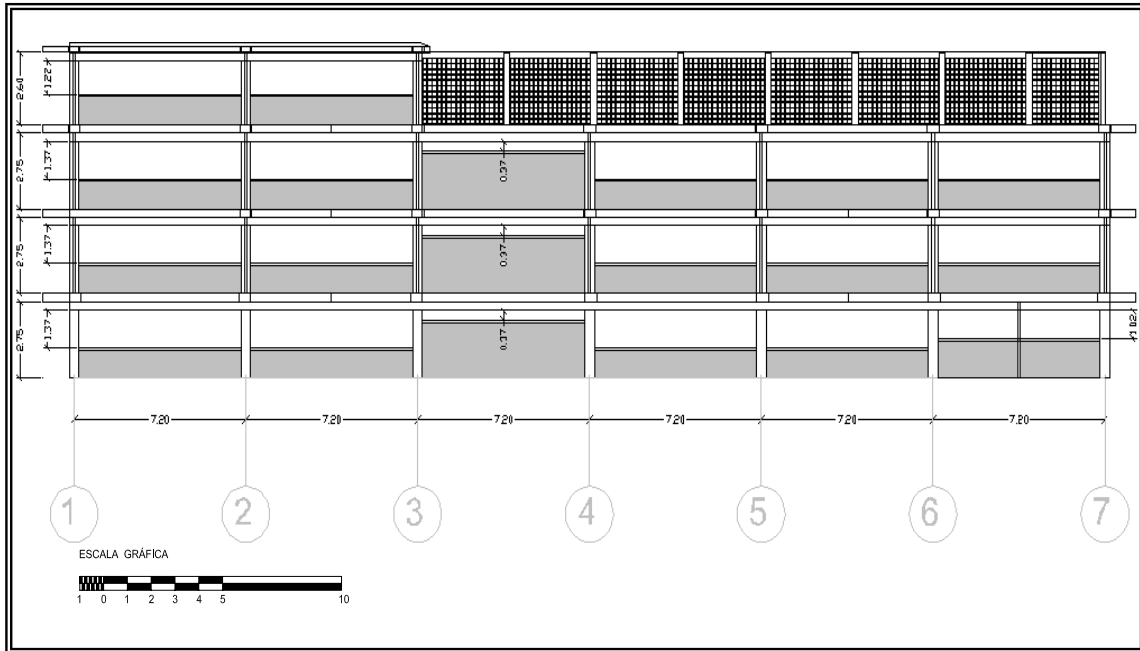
Pórtico A (este-oeste) mostrando las paredes de mampostería y la longitud efectiva de columnas
